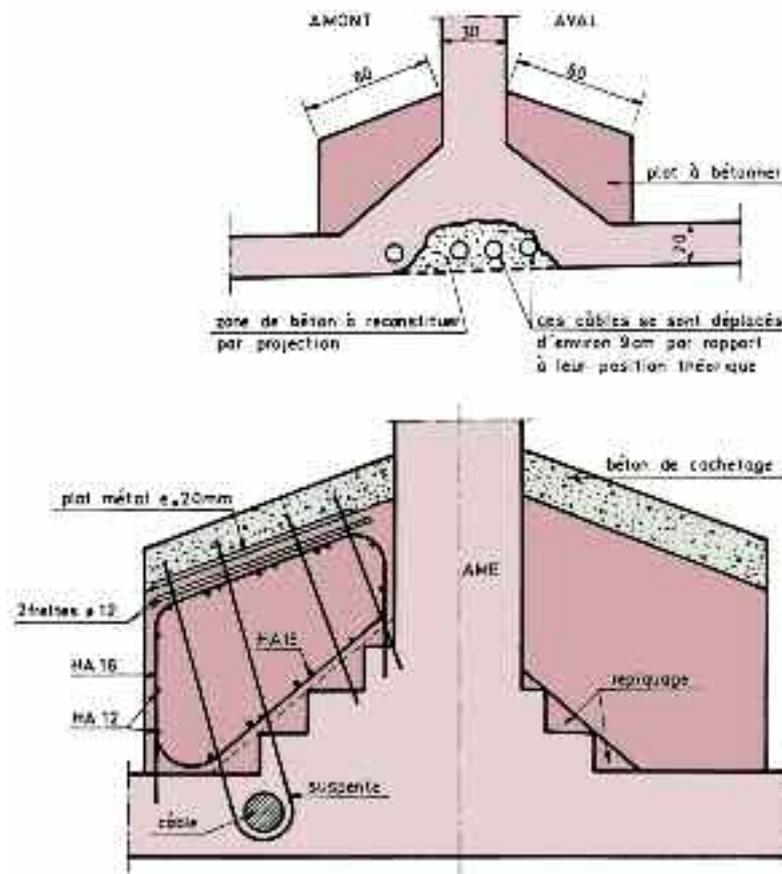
réparation d'une poussée au vide locale au pont Thinat à Orléans
